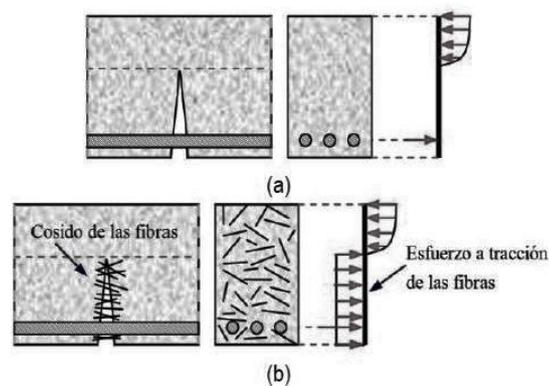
Control de fisuración con fibras metálicas en el concreto.
